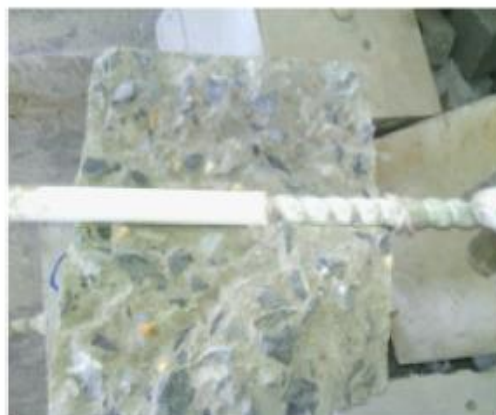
Ruptura por fendilhamento do concreto (XINGYU GU, BIN YU E MING WUB, 2015).
